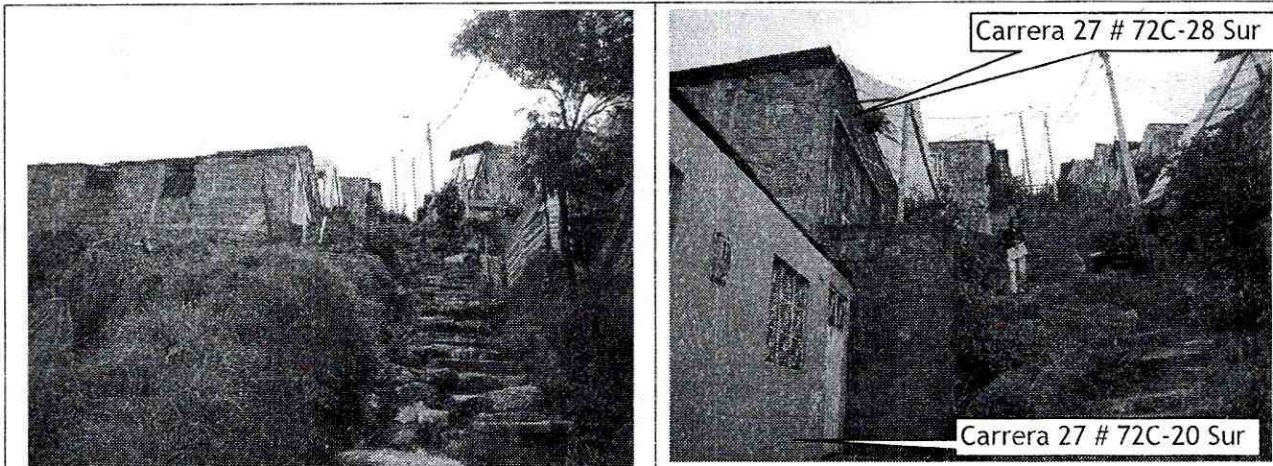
y 2. Sector donde se localizan los predios de la Carrera 27 # 72C-20 Sur y la Carrera 27 # 72C-28 Sur
